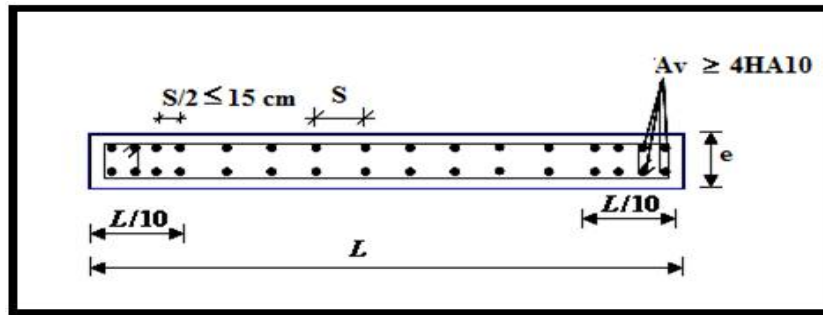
Disposition des armatures verticales dans les voiles.
